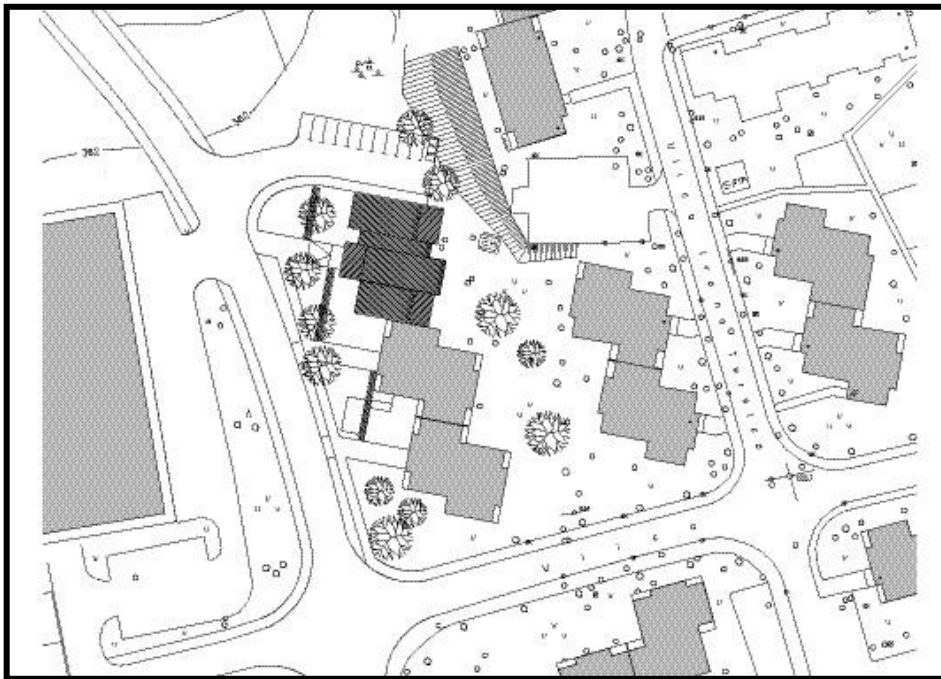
Planta de conjunto anterior con la nueva propuesta.
